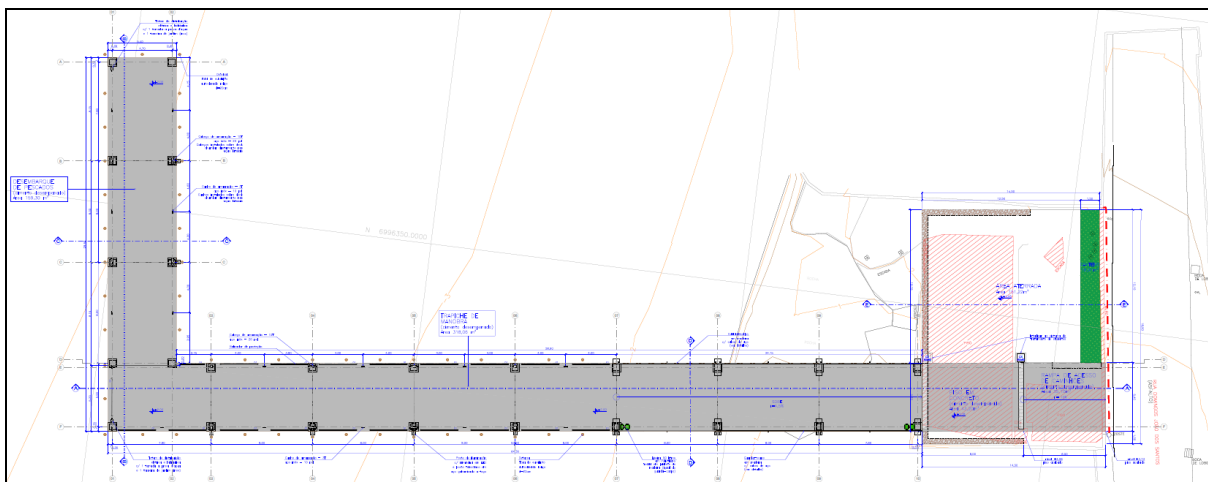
Recorte do Projeto Arquitetônico (Prancha 01/03)
